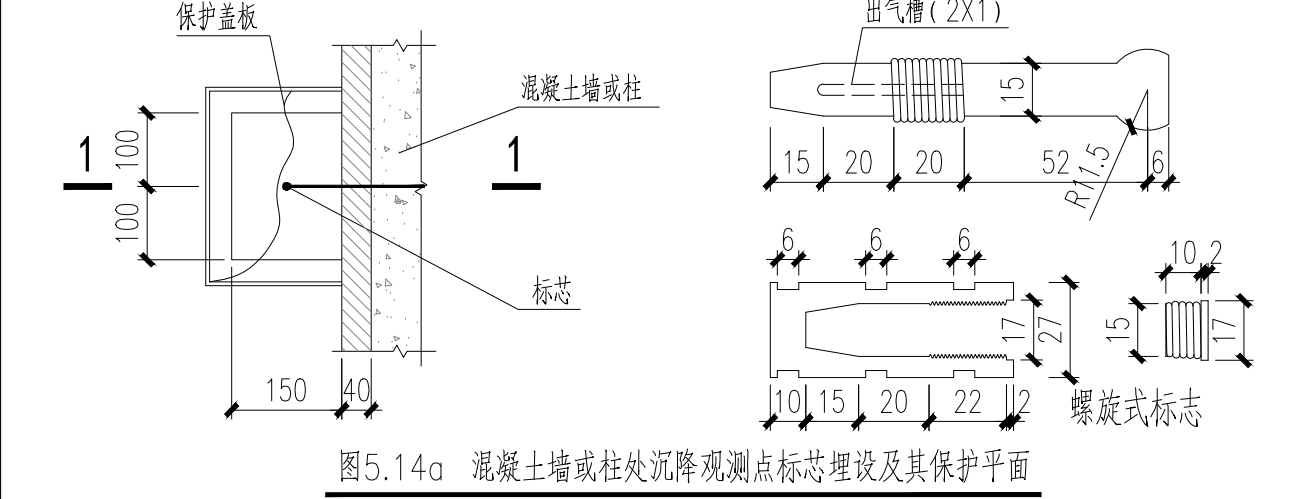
混凝土墙或柱处沉降观测点标志埋设及其保护平面
